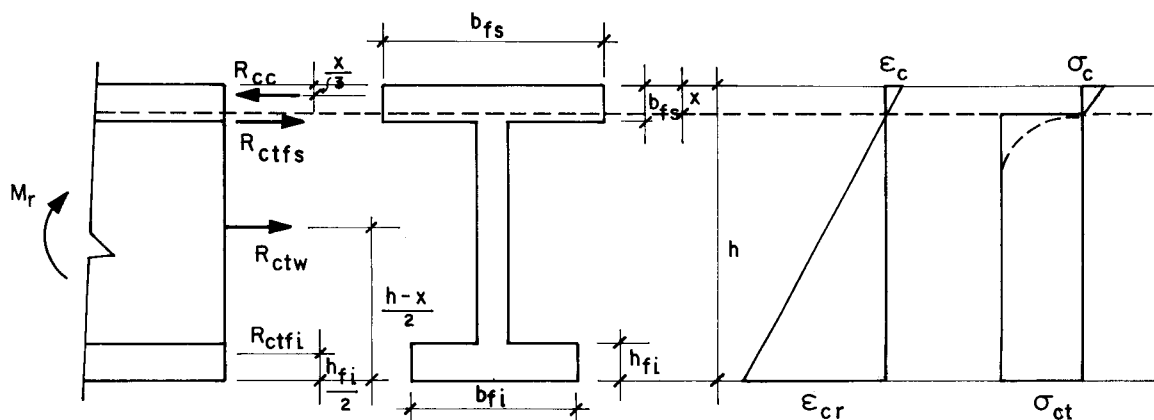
MOMENTO DE FISSURAÇÃO - LN NA MESA SUPERIOR
